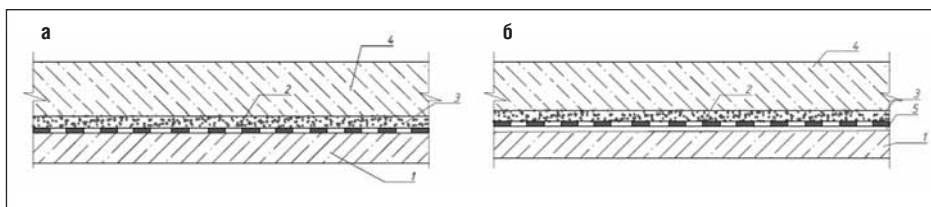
Бесшовная гидроизоляция лотковой (фундаментной) плиты с укладкой напыляемых составов с двухсторонней адгезией: а – бетонное покрытие; б – подстилающий слой из геотекстильной ткани; 1 – бетонная подготовка; 2 – слой гидроизоляции; 3 – защитный слой гидроизоляции; 4 – лотковая плита; 5 – подстилающий (армирующий) слой из геотекстильной ткани
